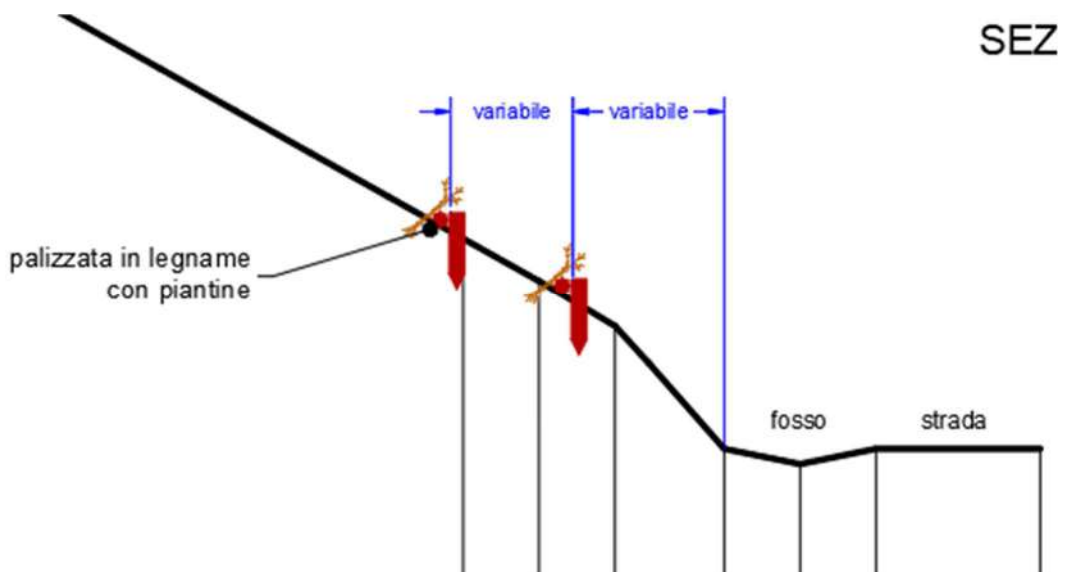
Sezione tipo palizzate. (rappresentazione non in scala)
